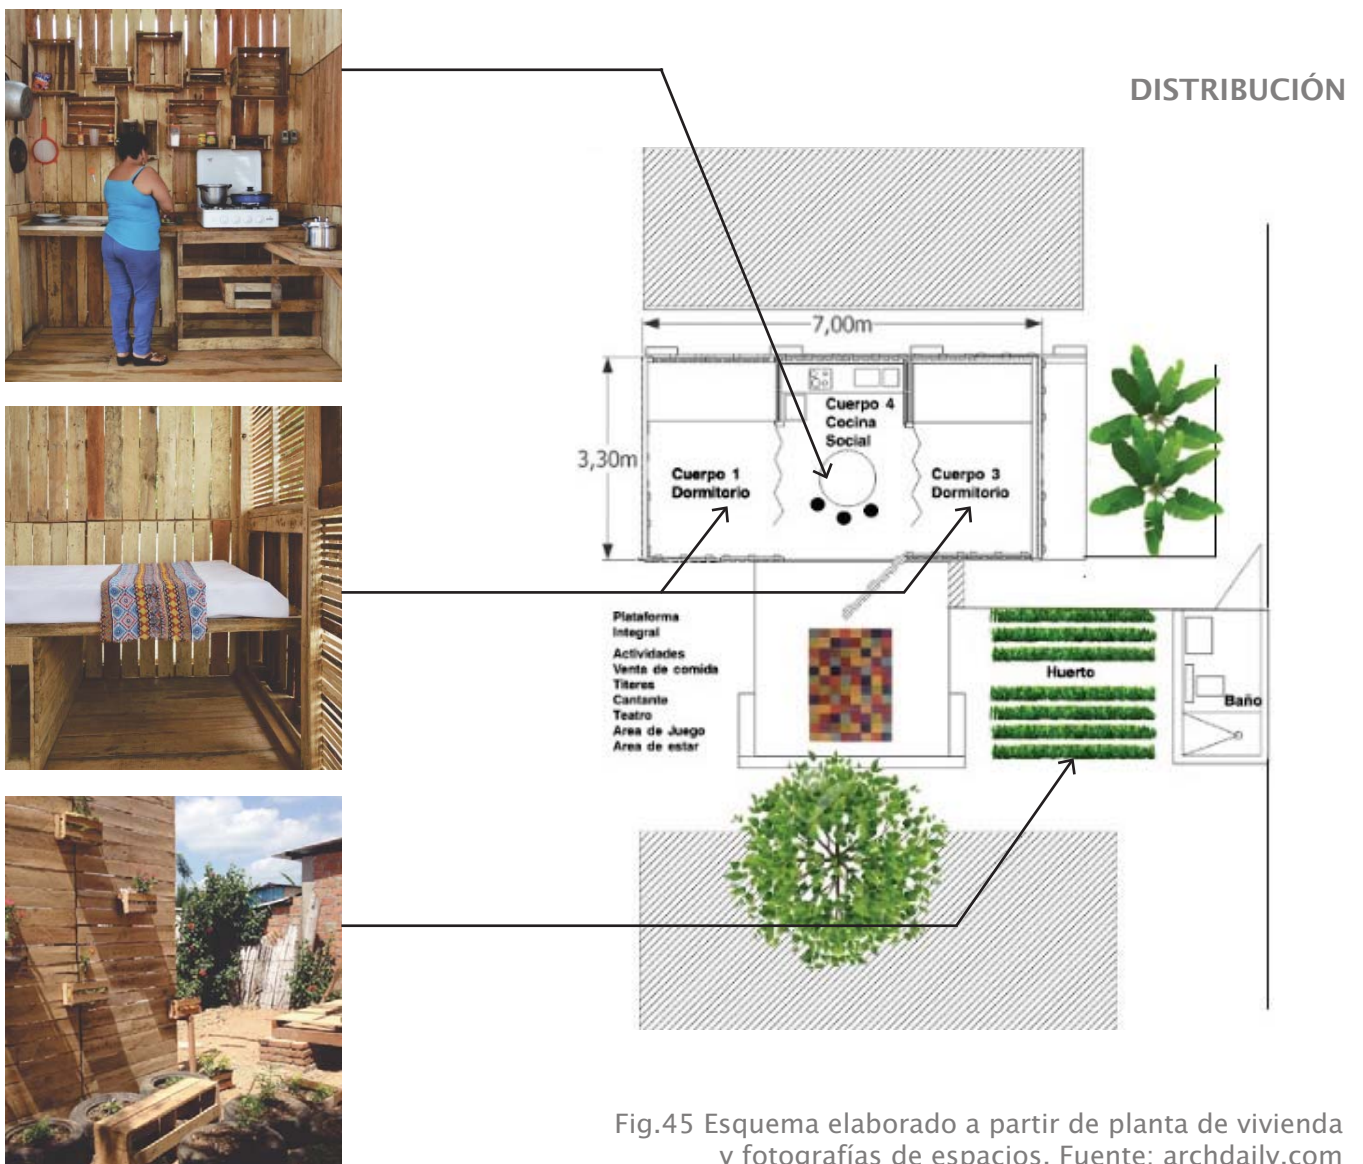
Esquema elaborado a partir de planta de vivienda y fotografías de espacios. Fuente: archdaily.com
